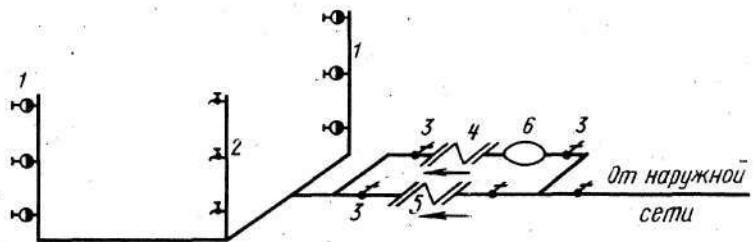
Схема внутреннего водопровода с пожарным насосом-повышителем
